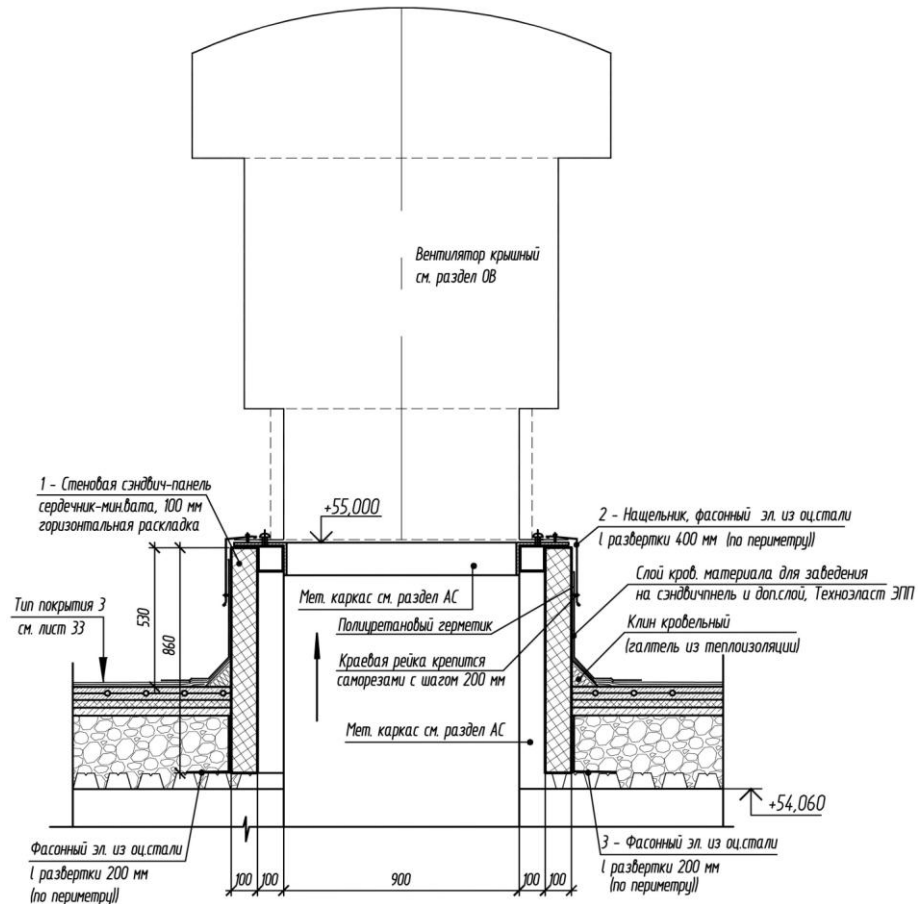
Устройство примыкания к вентиляционным шахтам
